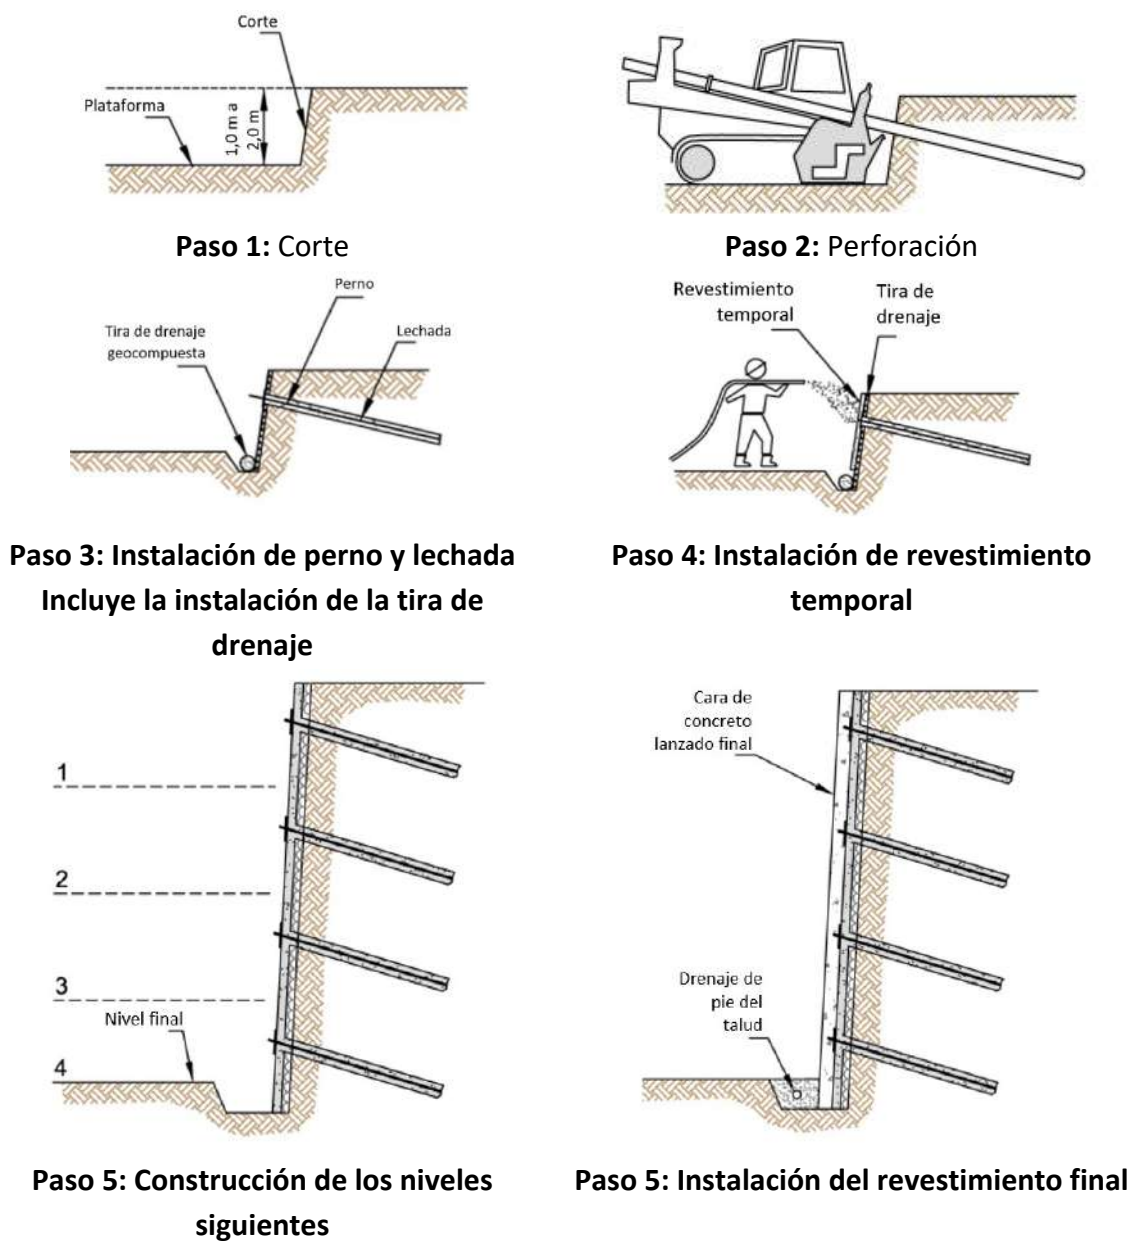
Secuencia constructiva de un muro de soilnailing
